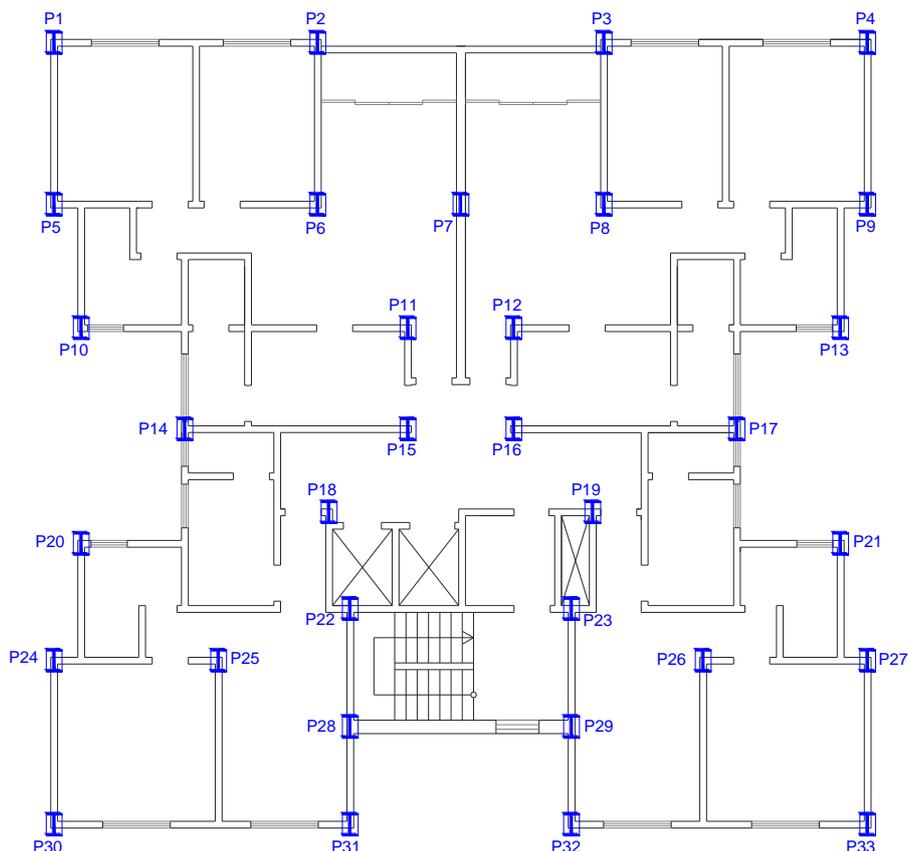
Localização dos pilares de aço em planta – Residencial Navarro.
